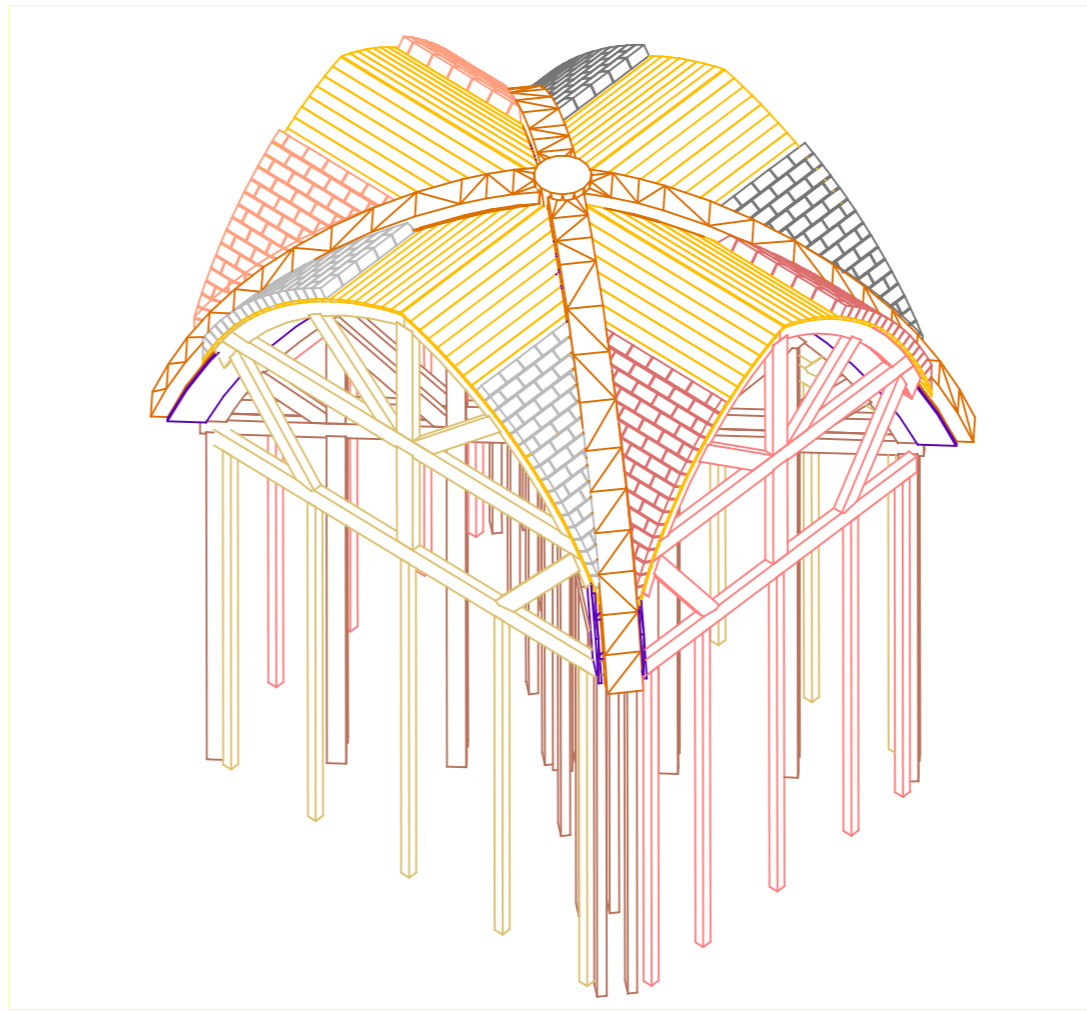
SEGUNDA FASE DE RECONSTRUÇÃO
